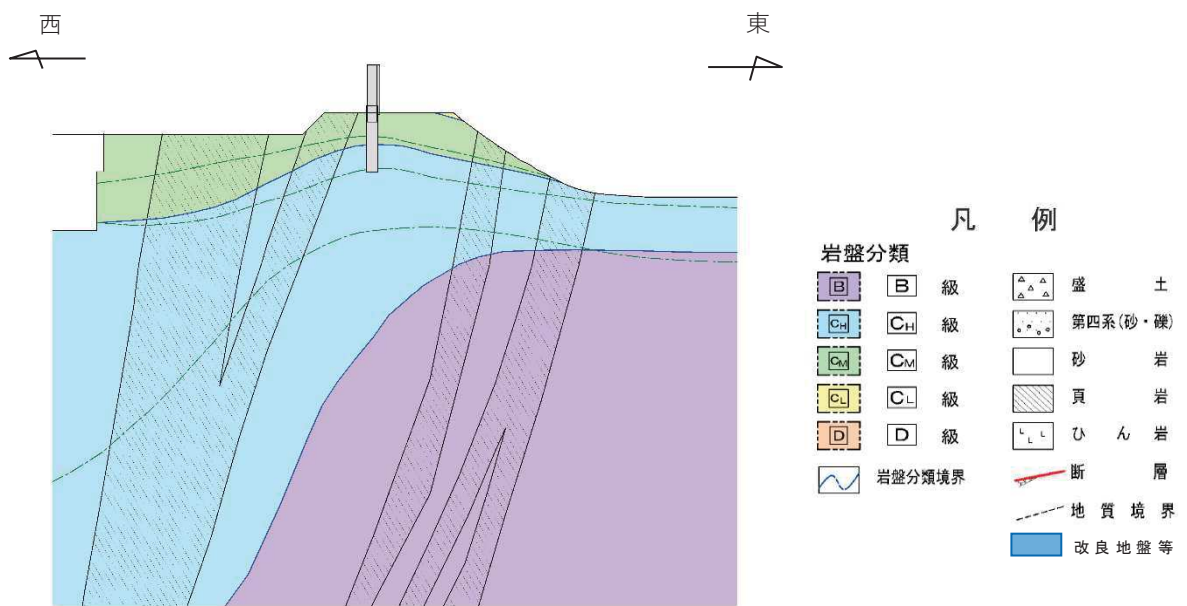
鋼管式鉛直壁（岩盤部）II-①断面（断面⑥）
